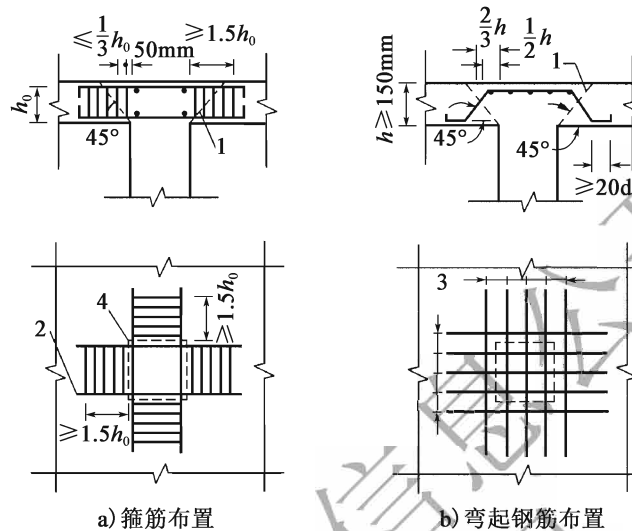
Dispositions des armatures transversales de poinçonnement dans la dalle supportée par un poteau unitaire
